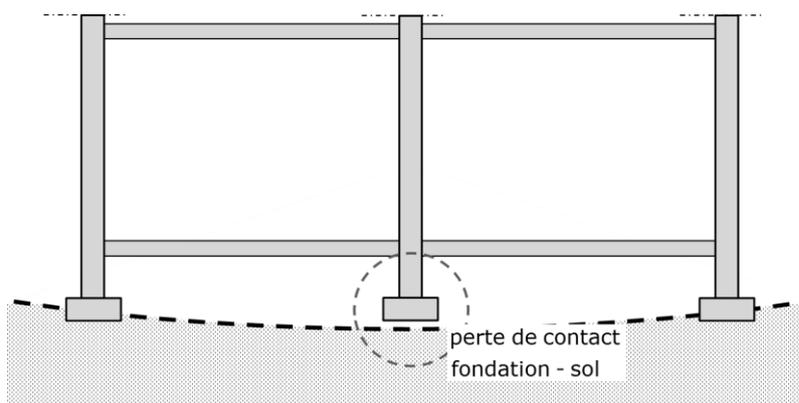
exemple d'une perte d'appui des fondations engendrée par une courbure concave du terrain
